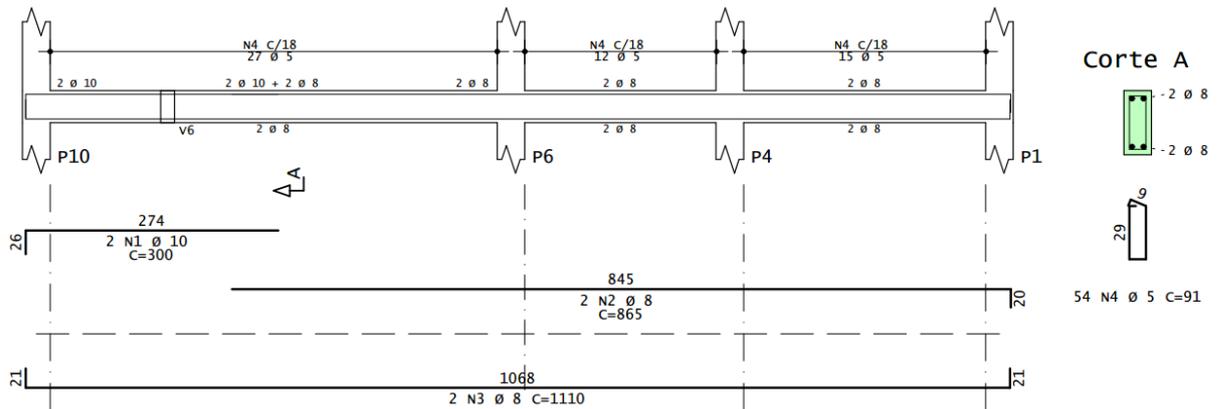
Armadura da viga baldrame V9 – pavimento térreo (nível 0,00)
